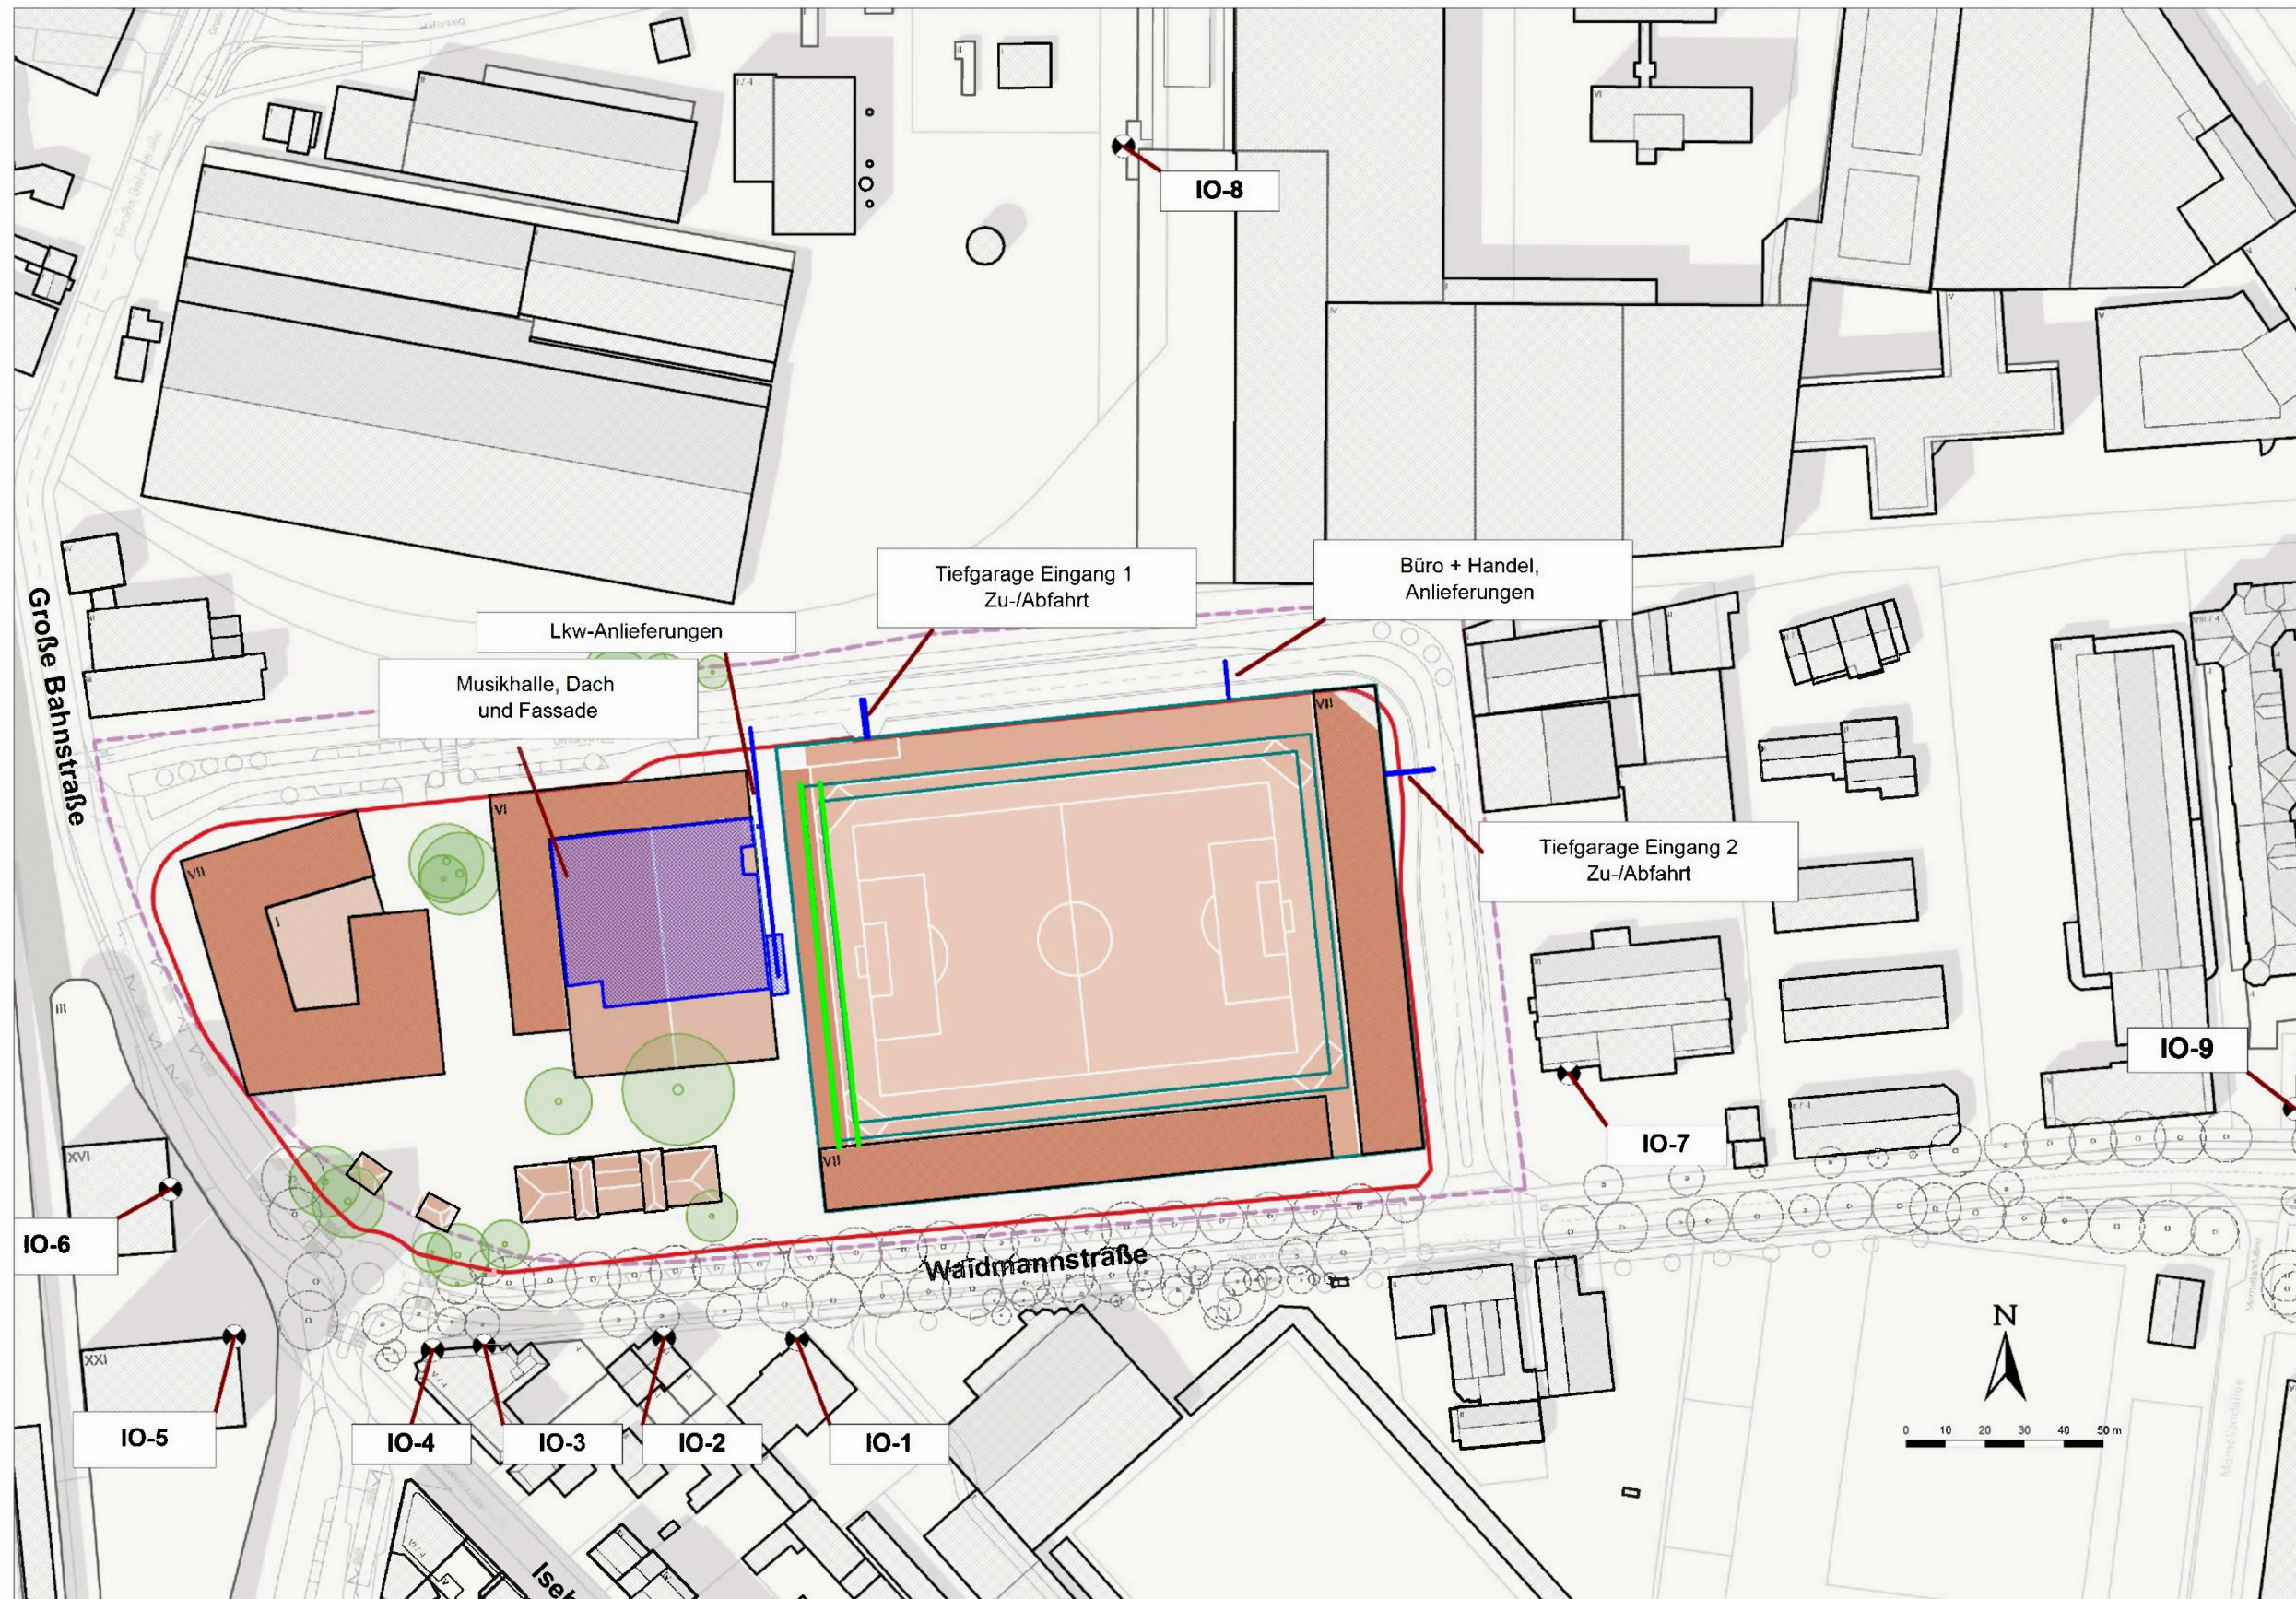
Lageplan mit maßgeblichen Immissionsorten sowie Lage der Gewerbelärmquellen.
